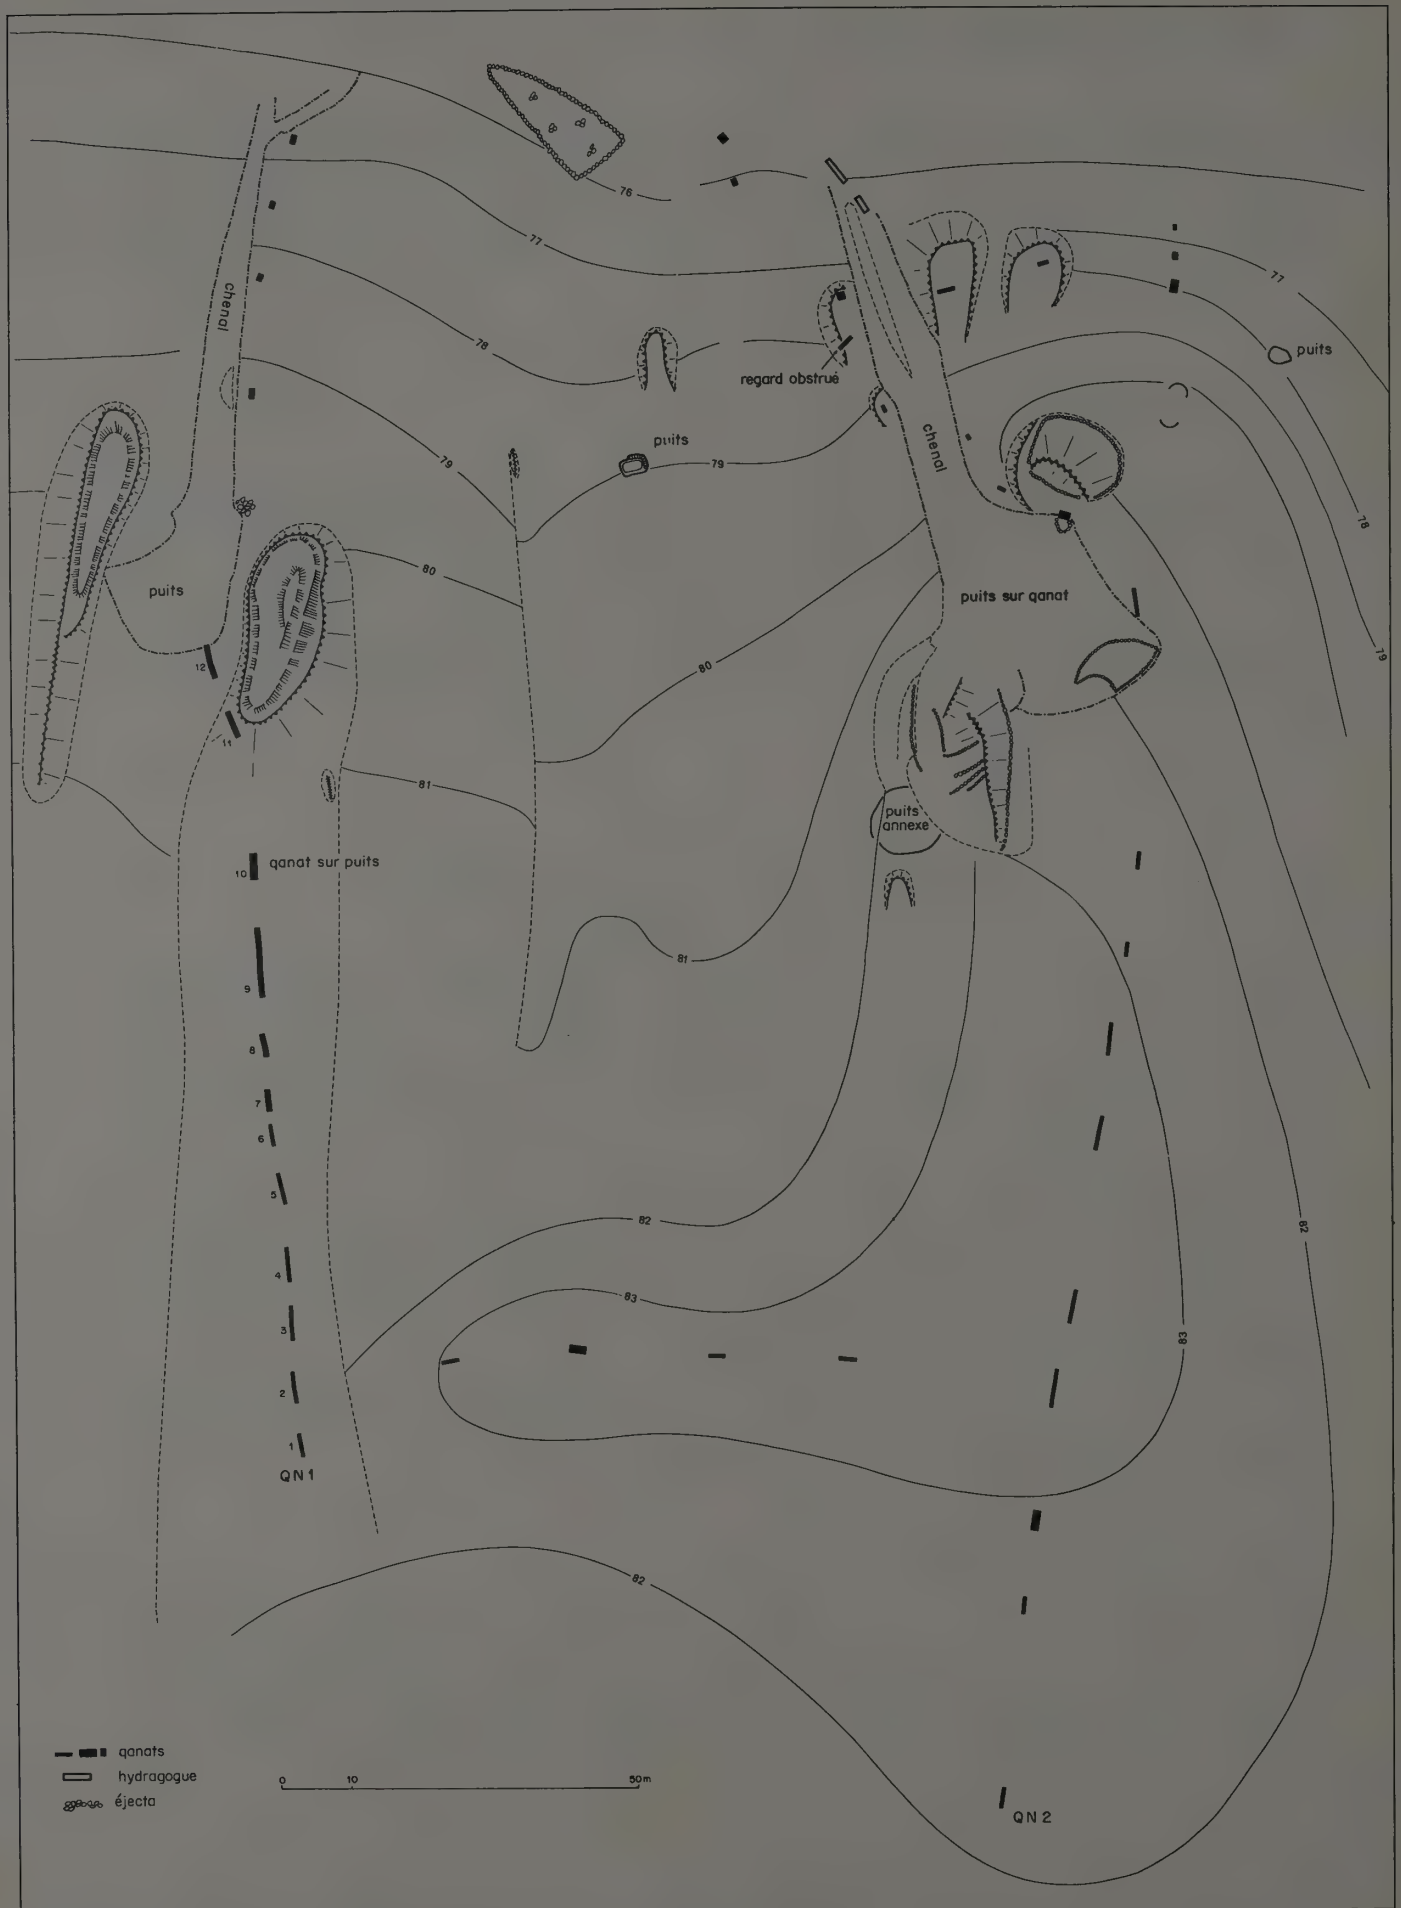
Dikura. Plan général des différentes installations hydrauliques. (Relevé Ch. Braun).
